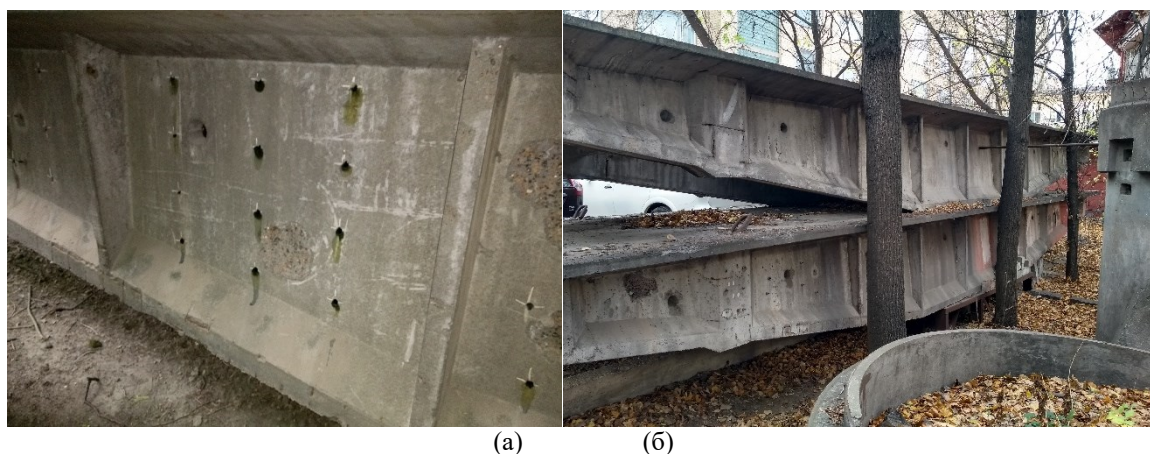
(а) – выполненные контрольные отверстия глубиной 30÷50мм на поверхности железобетонной конструкции; (б) – пример обследуемой железобетонной конструкции. Конструкции находятся на открытом воздухе более 15 лет
